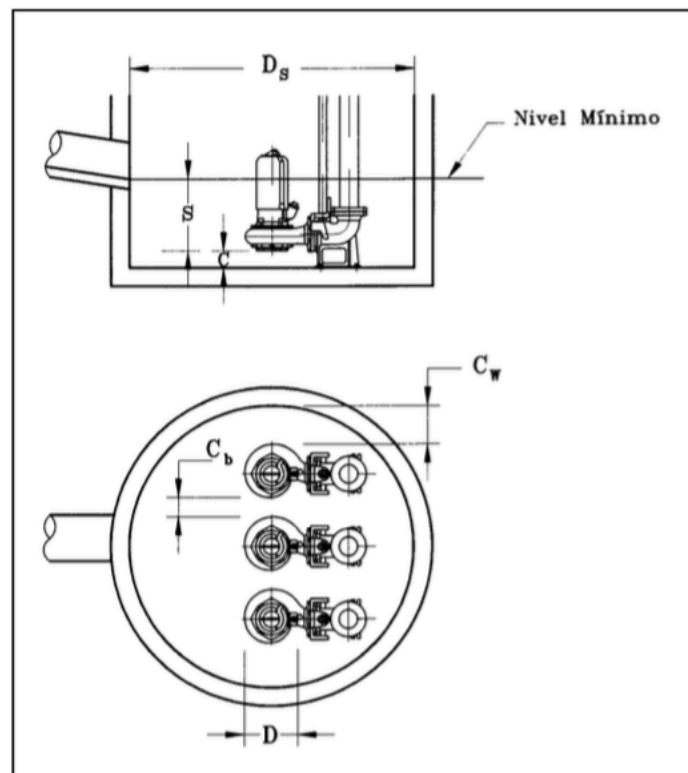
Recomendaciones para las dimensiones de pozo de planta circular (Fuente: ABS, manual para el proyectista)
